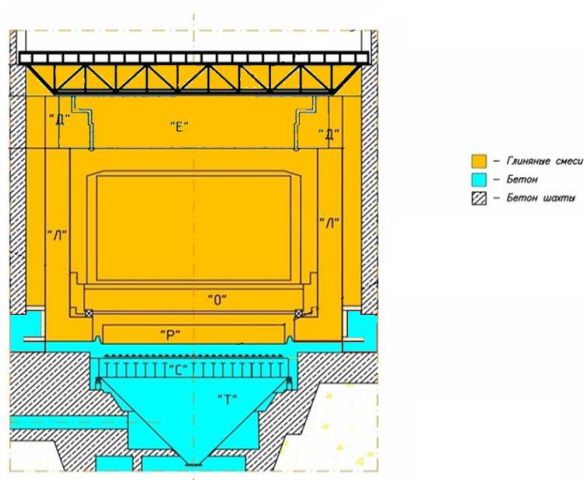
Схема реактора с дополнительными защитными барьерами
